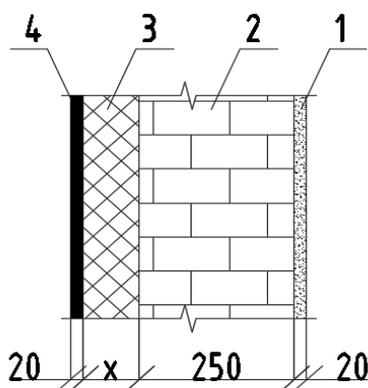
Эскиз ограждающей конструкции: 1 – цементно-песчаный раствор; 2 – полнотелый кирпич; 3 – утеплитель; 4 – вентиляруемый фасад
